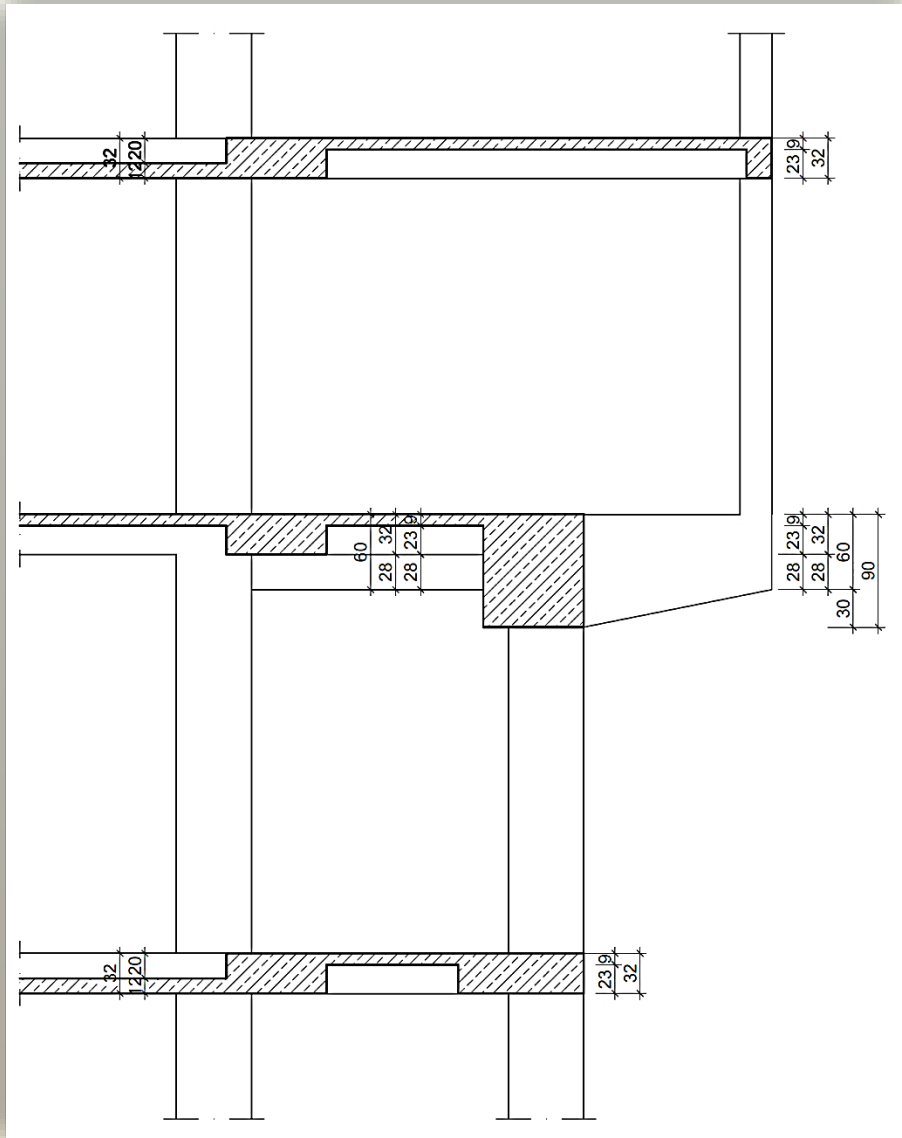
Mevcut Zemin Kat Tavanı Kalıp Planı
